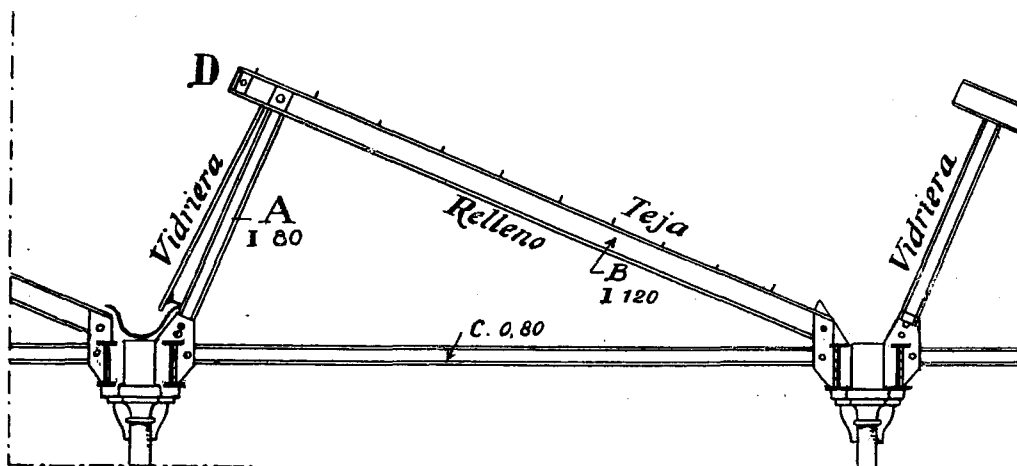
Armaduras en diente de sierra para luces de 4 a 6 m.
